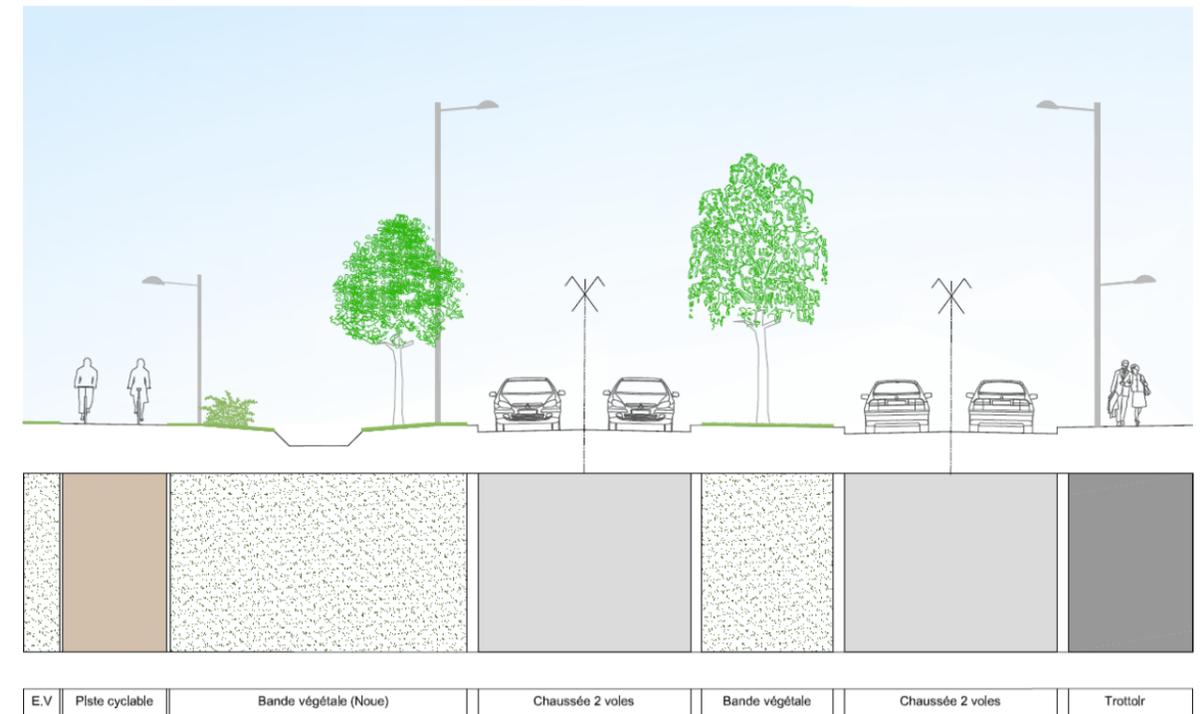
Coupe de principe sur le Boulevard Ouest – Section 2
